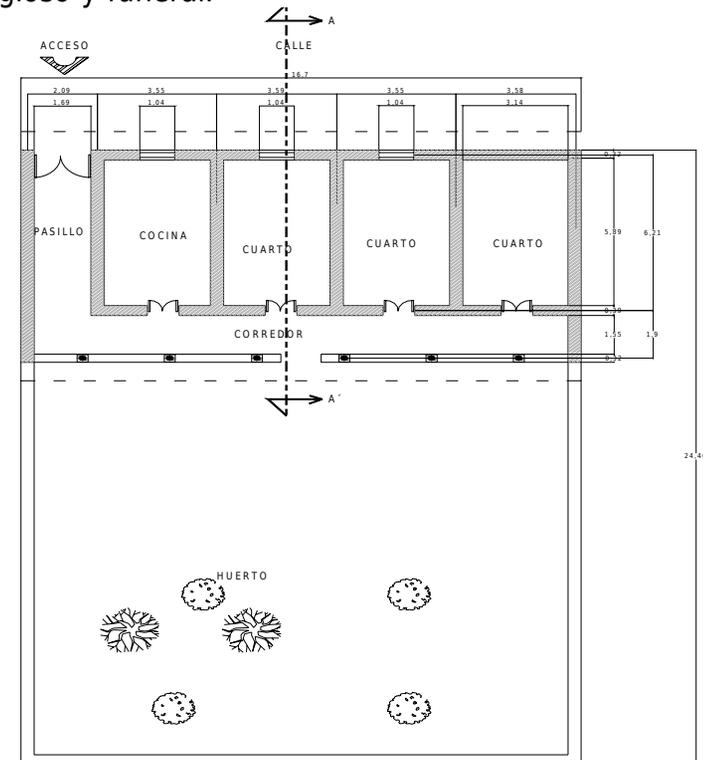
PLANTA ARQUITECTONICA DE LA VIVIENDA TIPO.
